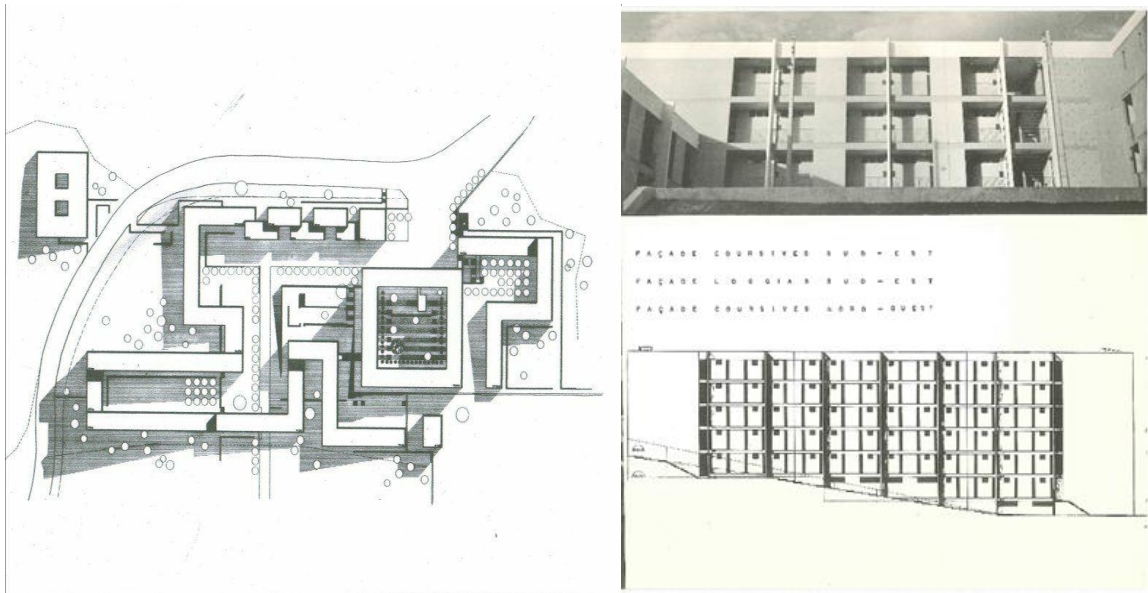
Plan de masse de la cité El Bir et vue sur la façade nord-ouest de la cité El Bir
